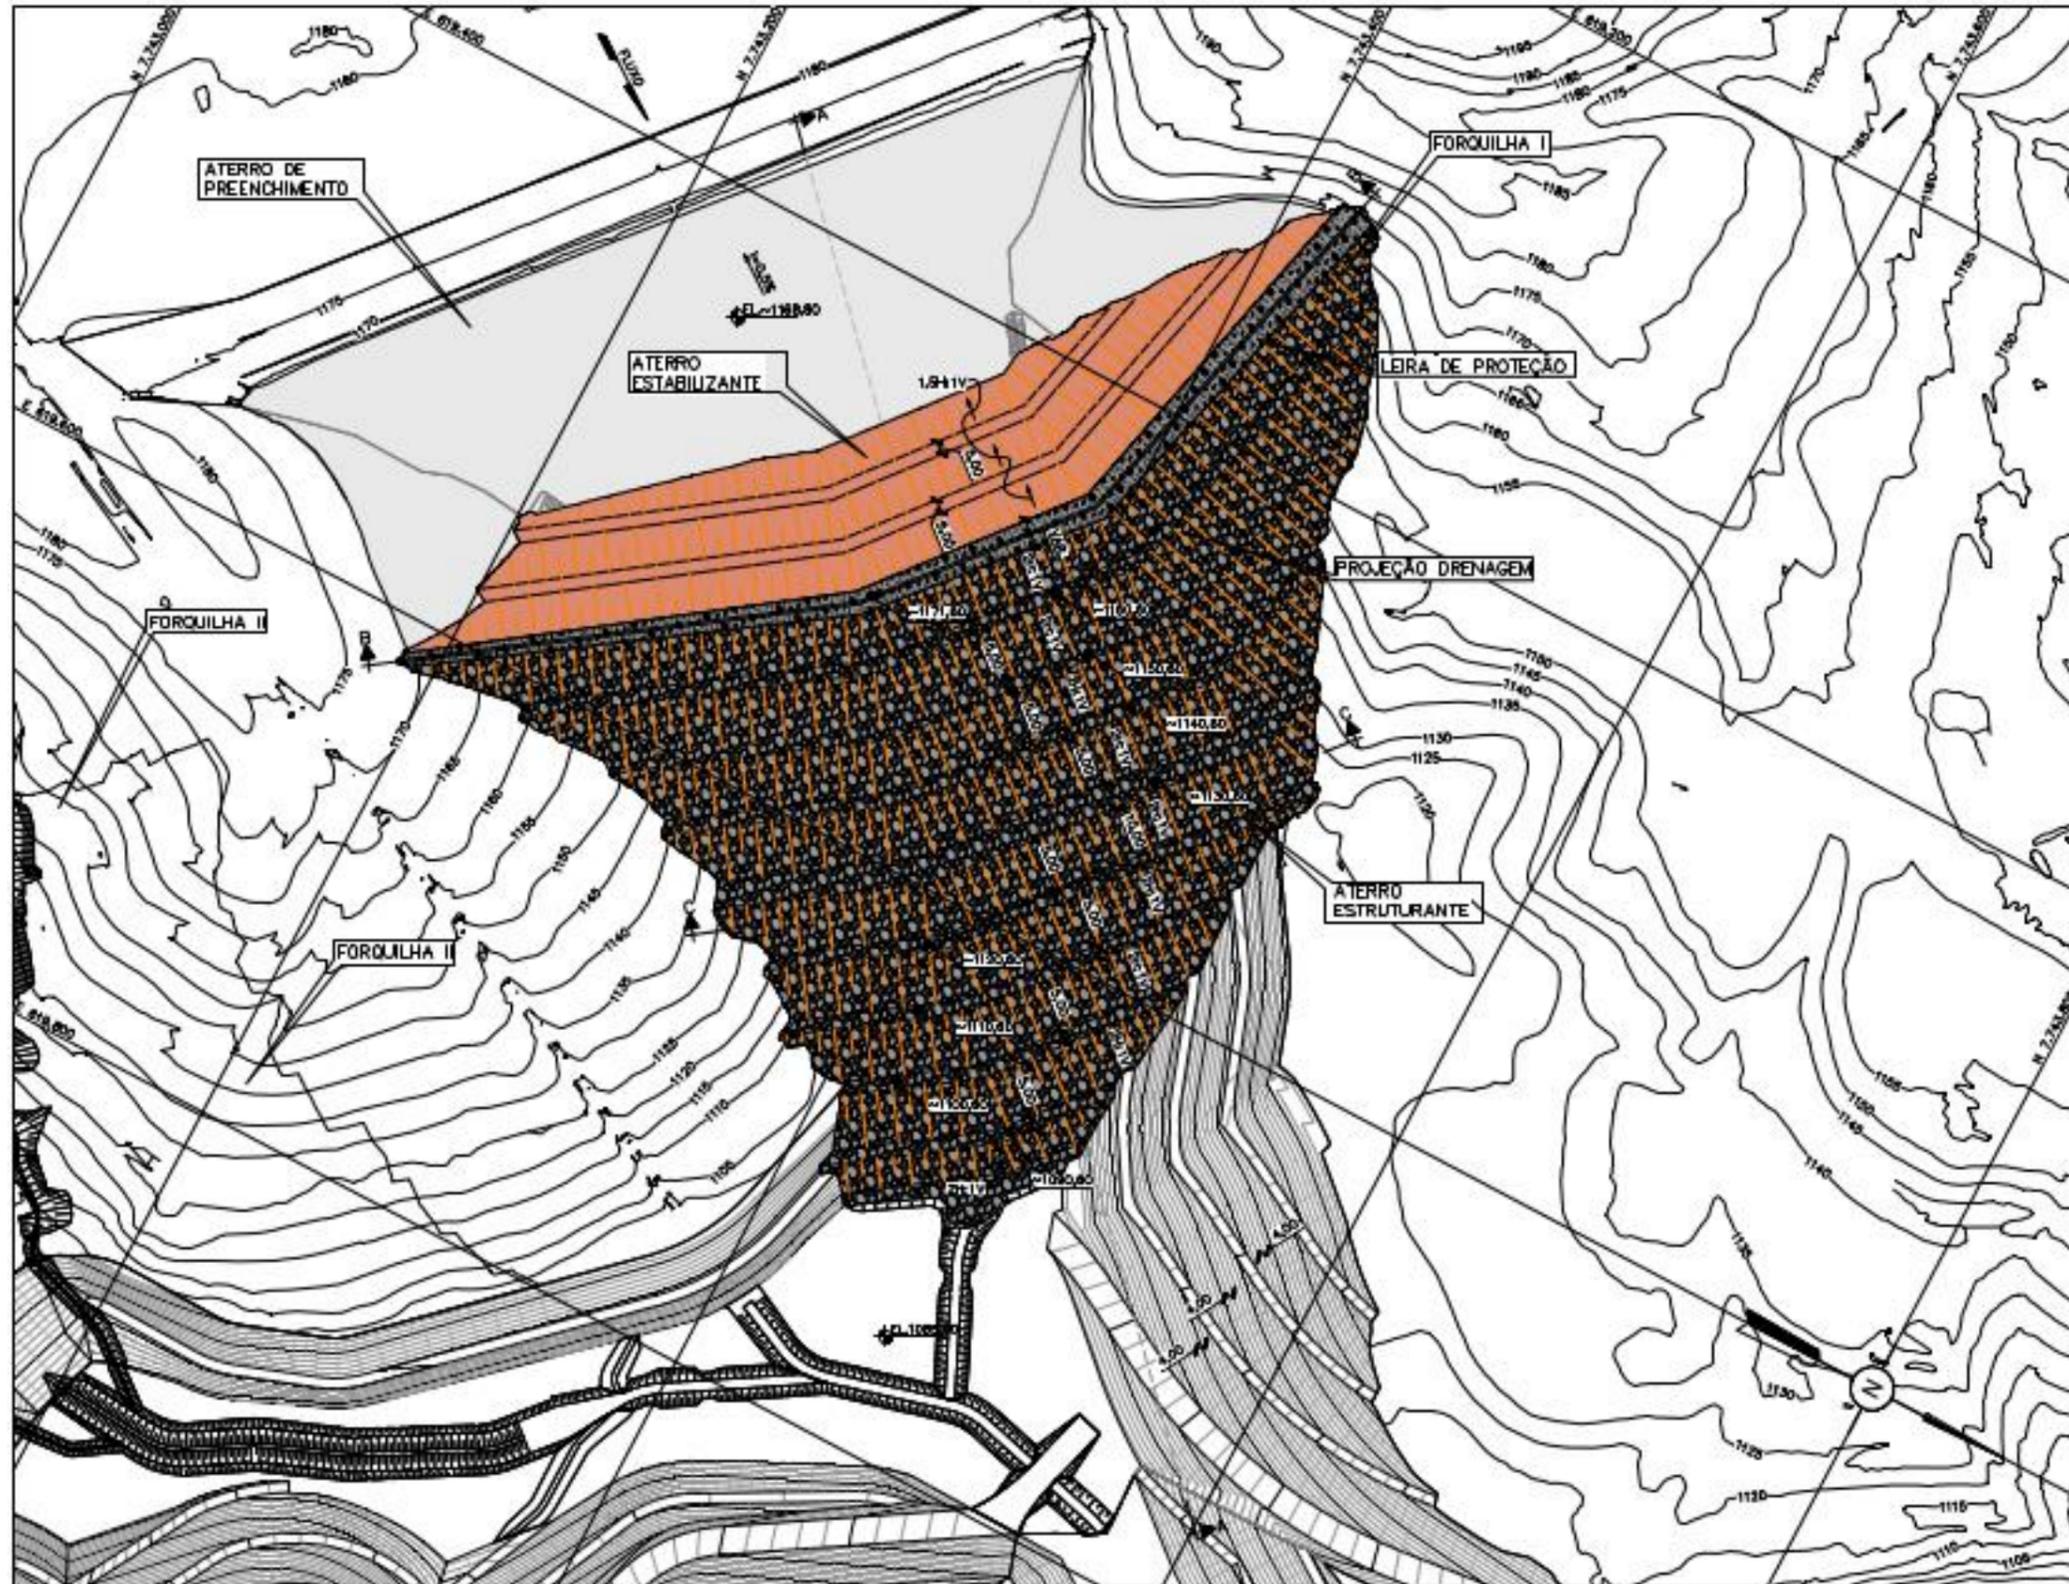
Geometria de descaracterização – Arranjo geral - Forquilha I (Fonte: 1850HH-X-41381– Intertechne)
